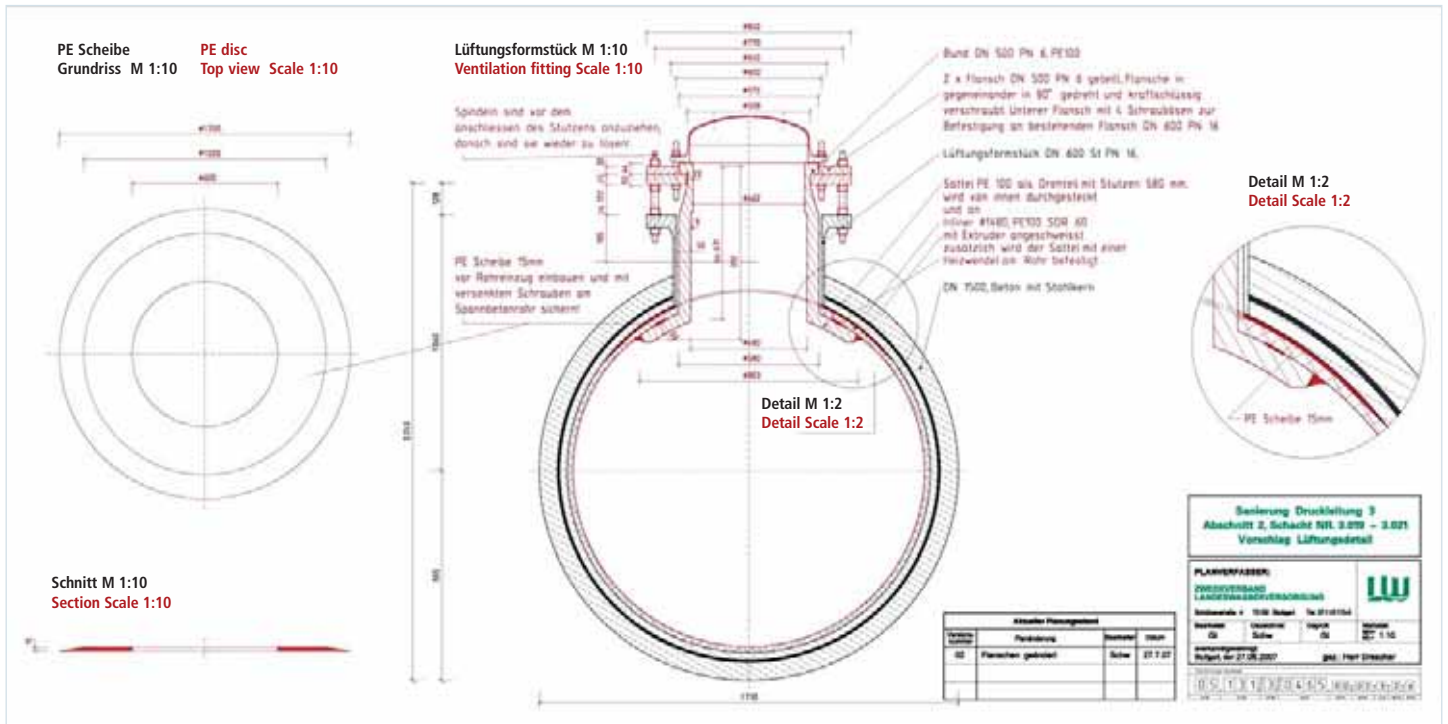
Detail Lüftungsdom DN 500 eingeschweißt in PE-Liner und Flanschverbindung zum Stahlrohr (Grafik LW)
